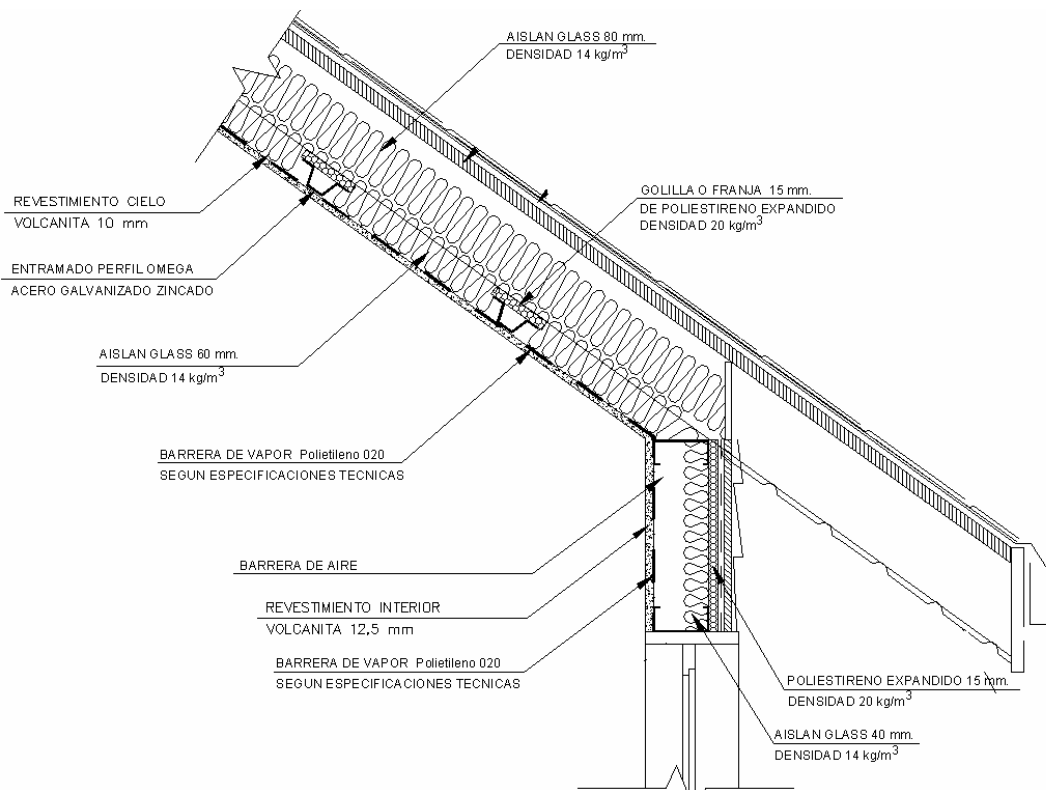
Sistemas de Aislamiento Térmico del Muro Perimetral y Cielo inclinado de las viviendas.
